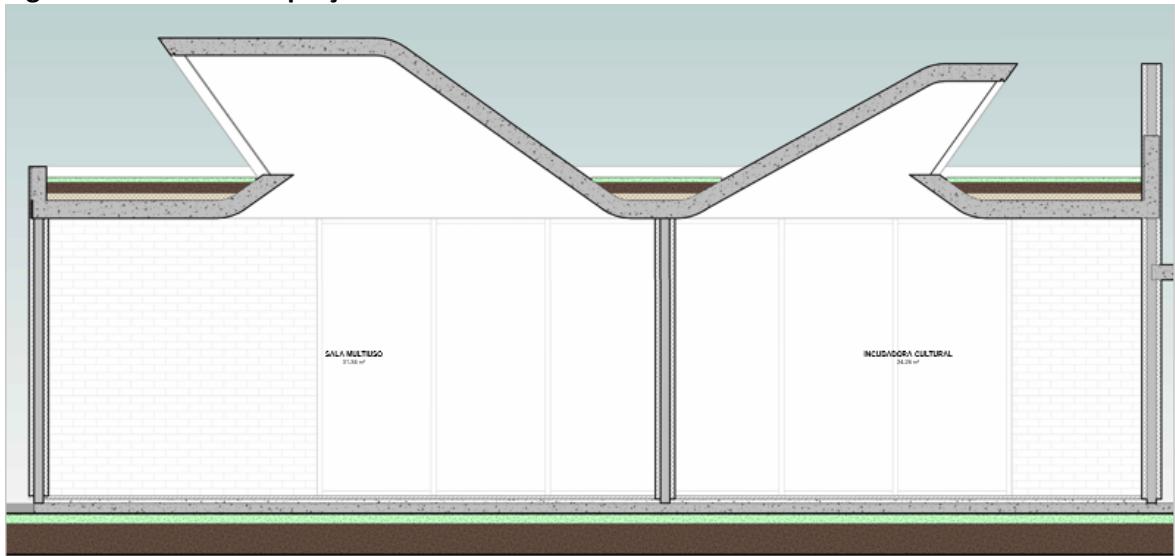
Paredes com grande inércia térmica e laje ajardinada.
